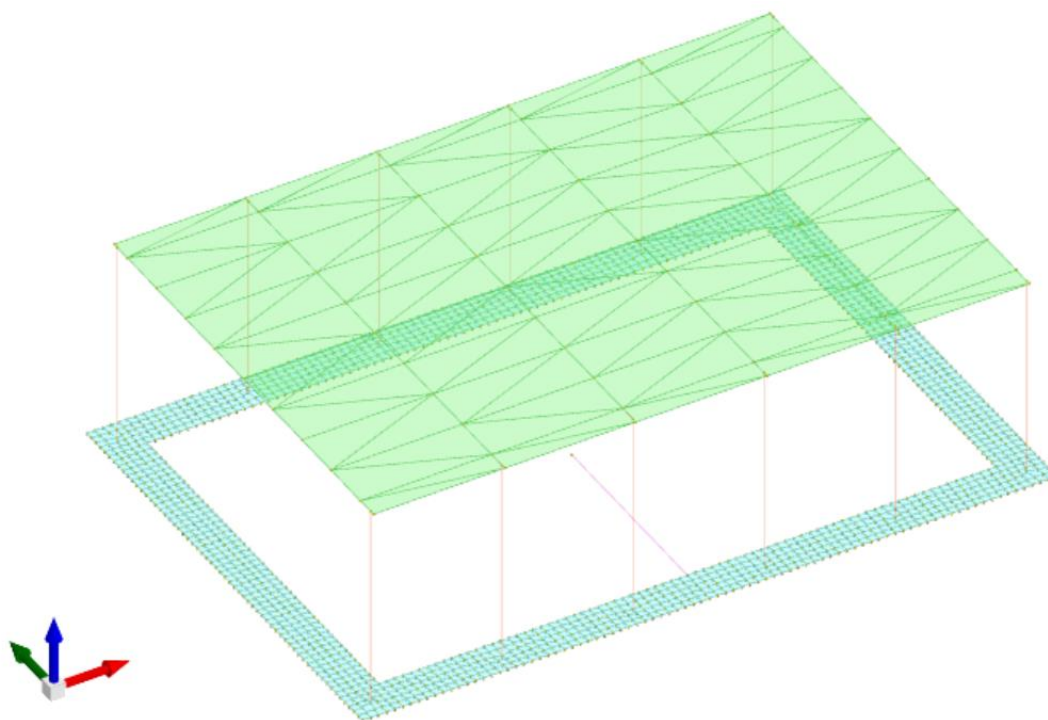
Modello di Calcolo comprensivo delle fondazioni
